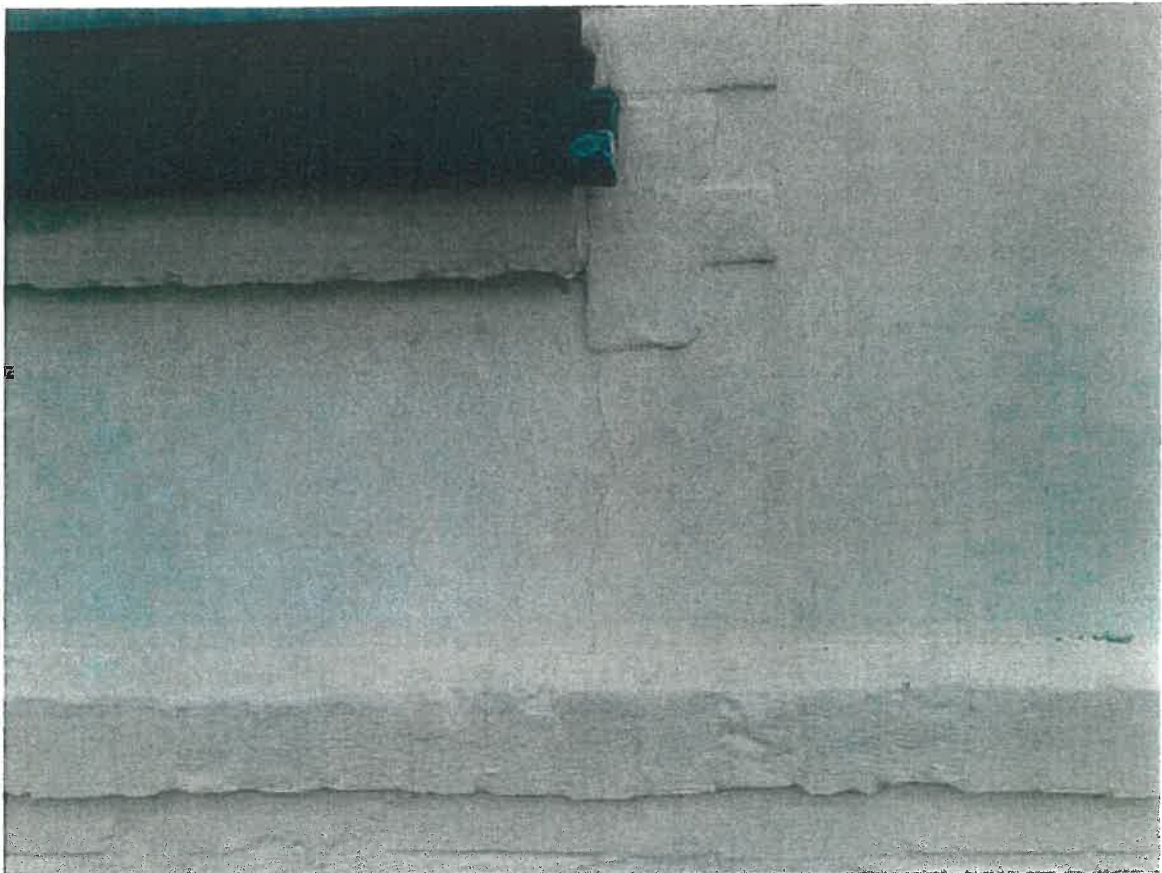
Risse an der straßenseitigen Westseite im Bereich einer älteren Fassadensanierung im EG
